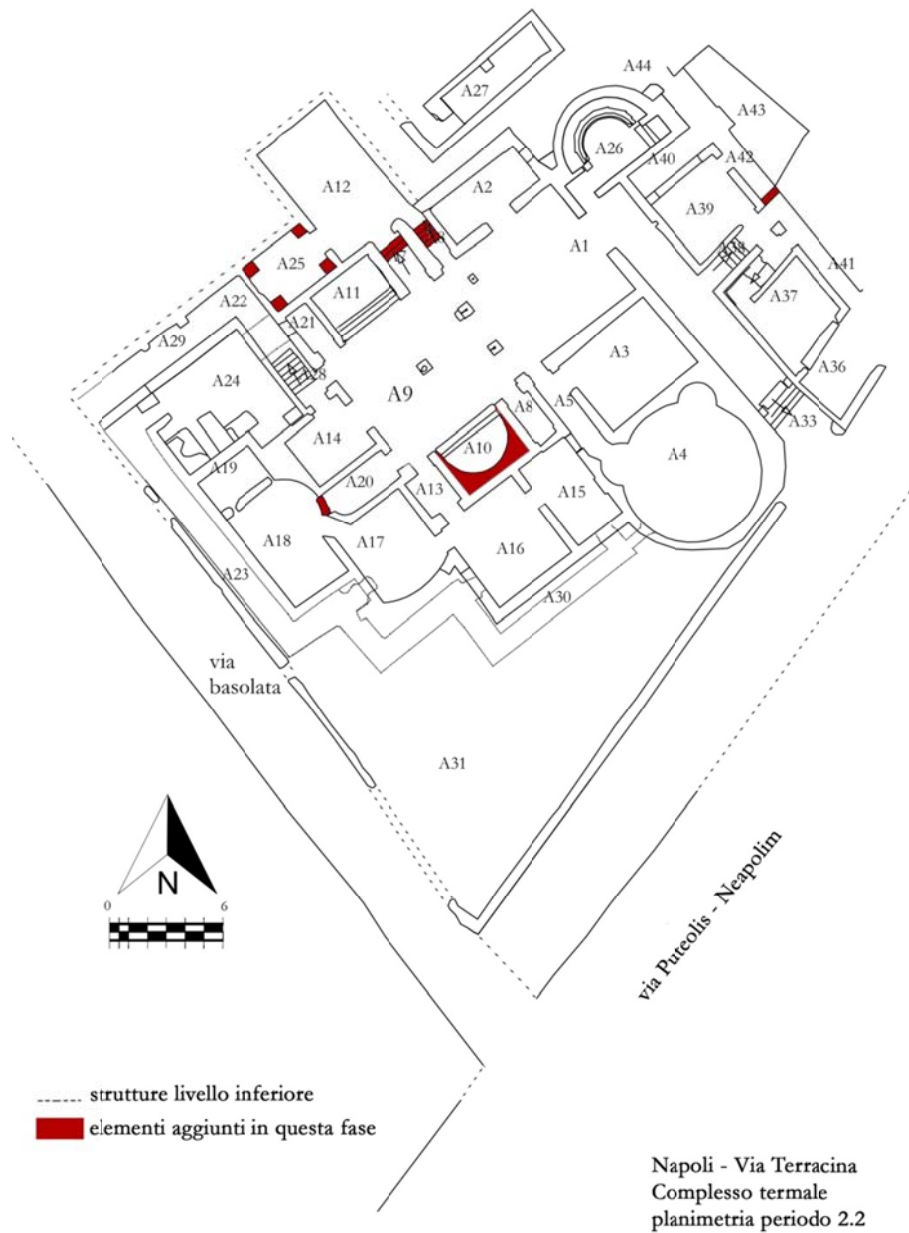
Planimetria dell'impianto del periodo 2.2
